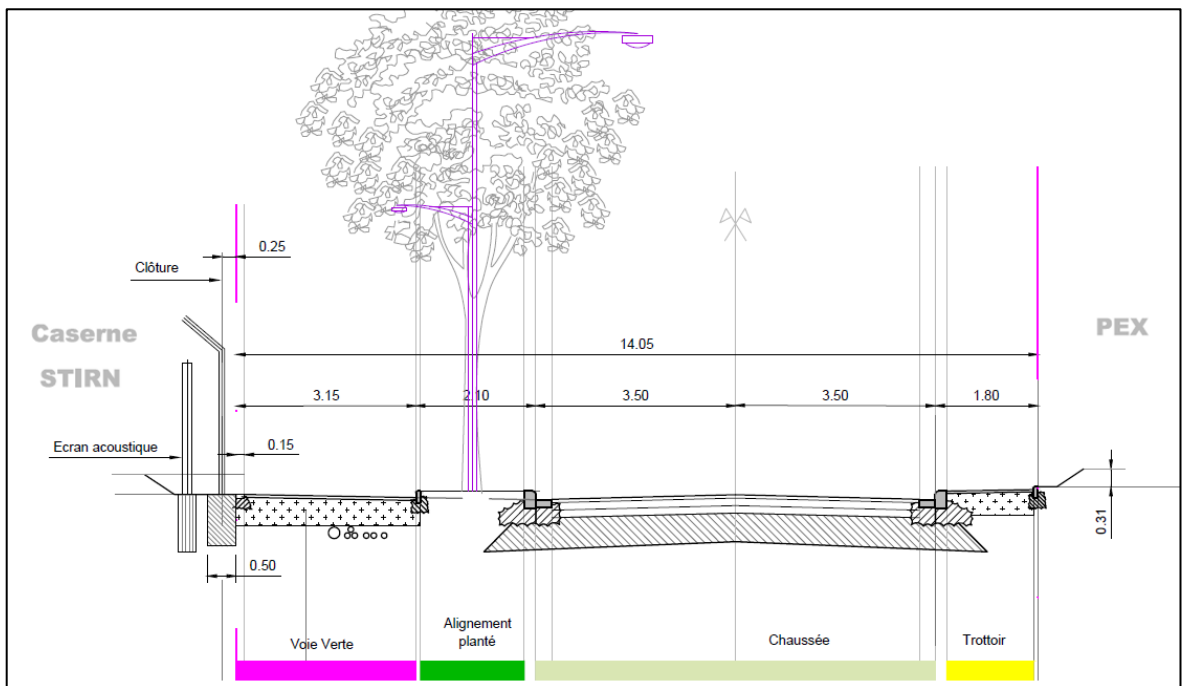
Profil en travers BB' de la voirie au droit du point bas du projet
